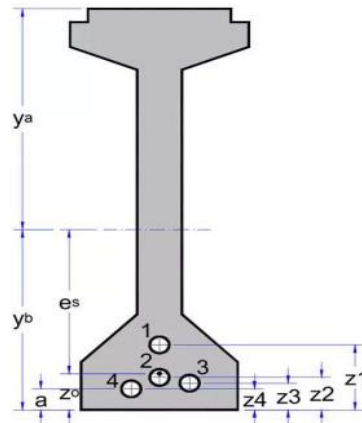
40 Trace 0 m dari tumpuan girder bentang 34m
